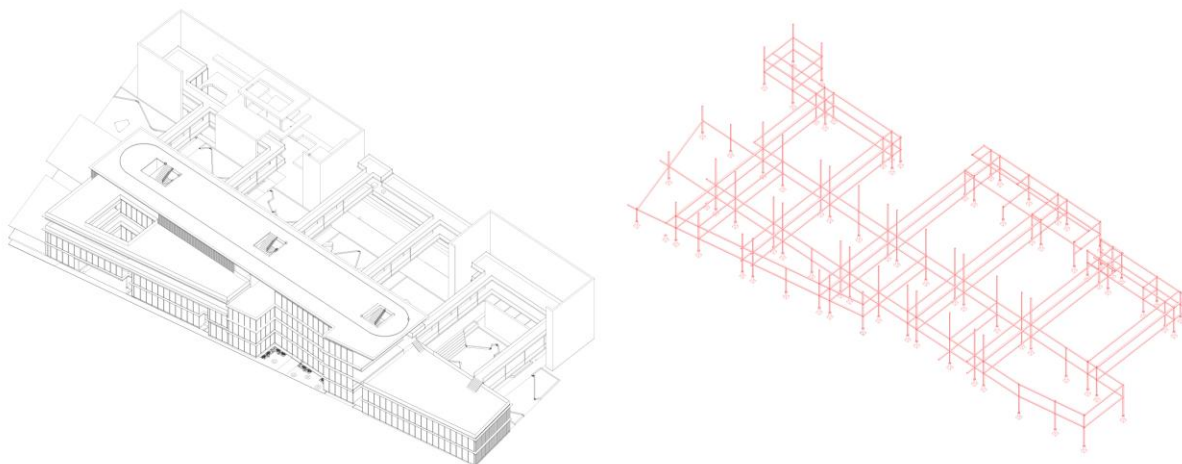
Representación isométrica pilares constructivos. Fuente: Elaboración propia
